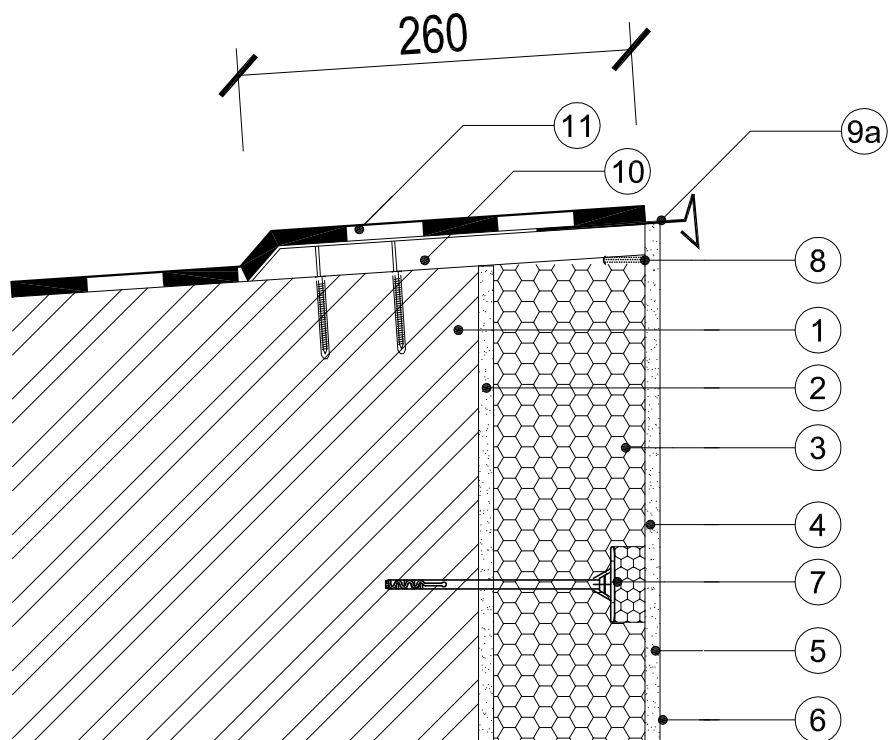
# DETAIL F (VZOROVÝ DETAIL - NAPOJENÝ ATIKY)
